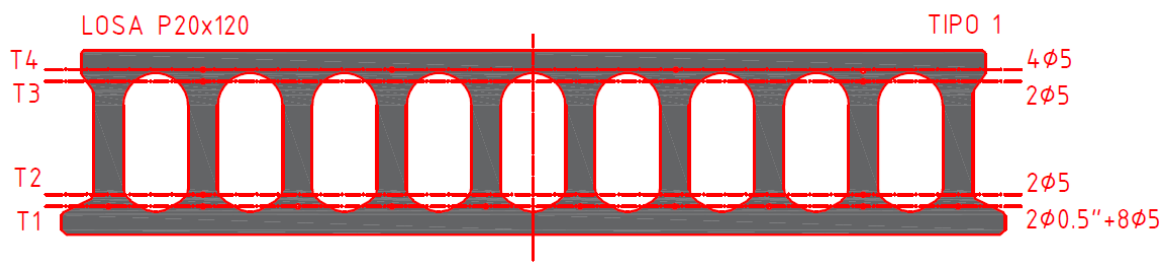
Armado del elemento prefabricado (20+5) x 1.2 metros, tipo T1.
